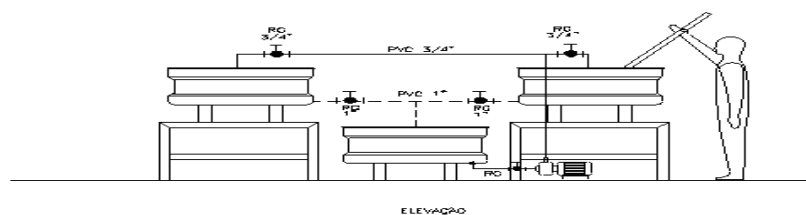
Planta elevada de mini centrais de reciclagem de lâmpadas fluorescentes.
